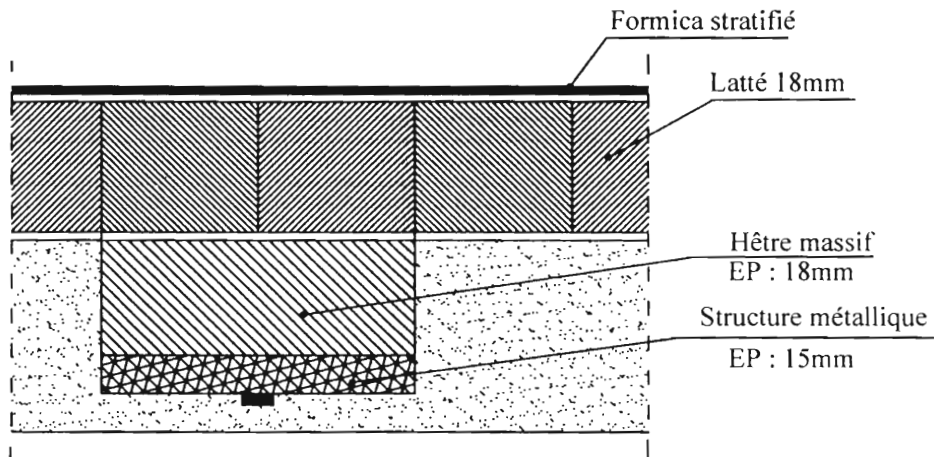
DETAIL DE LA PLANCHE DE TRAVAIL OU TOP
